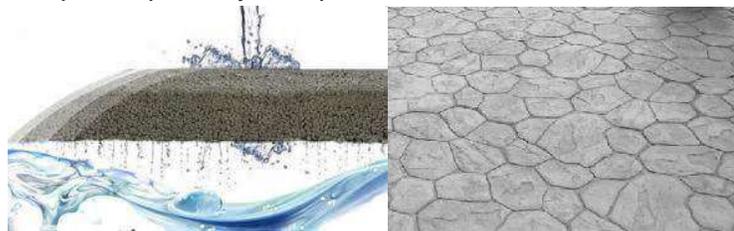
/concreto permeable y piso de piedra/foto obtenida de <https://www.google.com>
